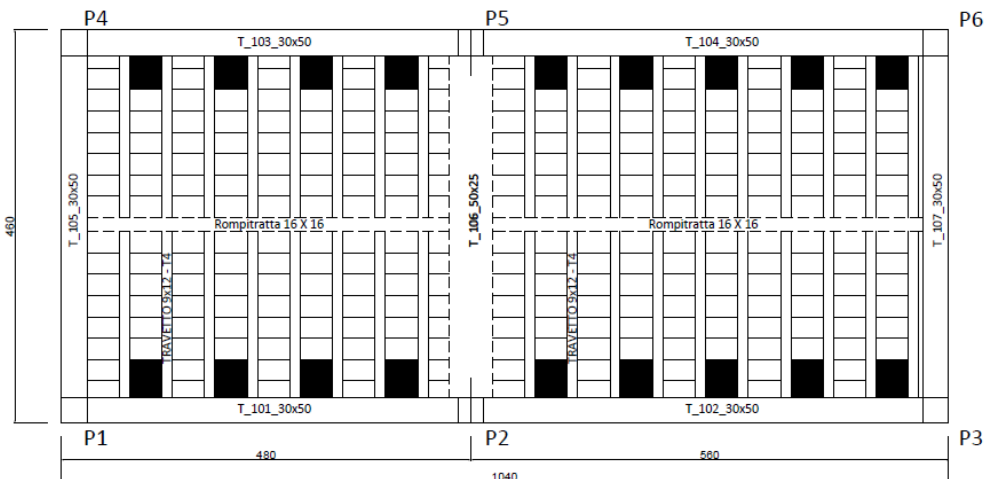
Carpenteria piano terra: disposizione dei telai e orditura solai (Strutturale)
